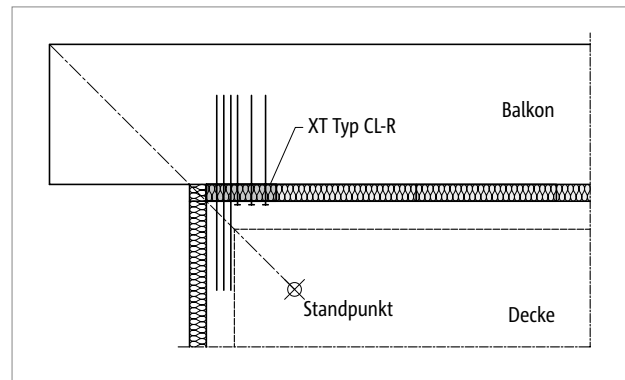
Schöck Isokorb® XT Typ CL: Balkon über Gebäudeecke auskragend (Einsatz XT Typ CL-R)
